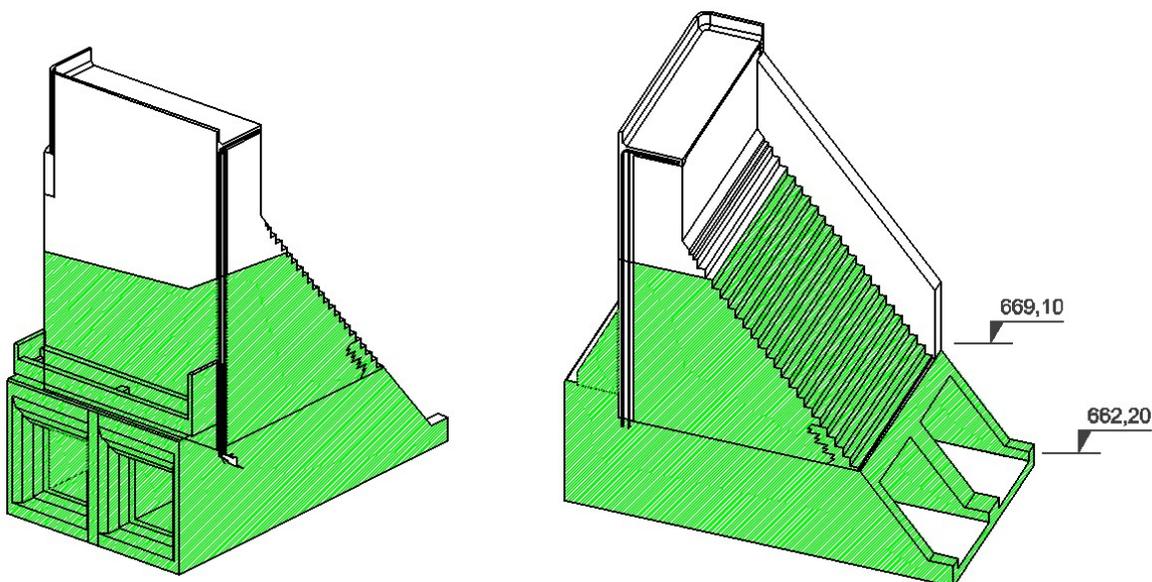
Acompanhamento da concretagem da estrutura de desvio do rio
